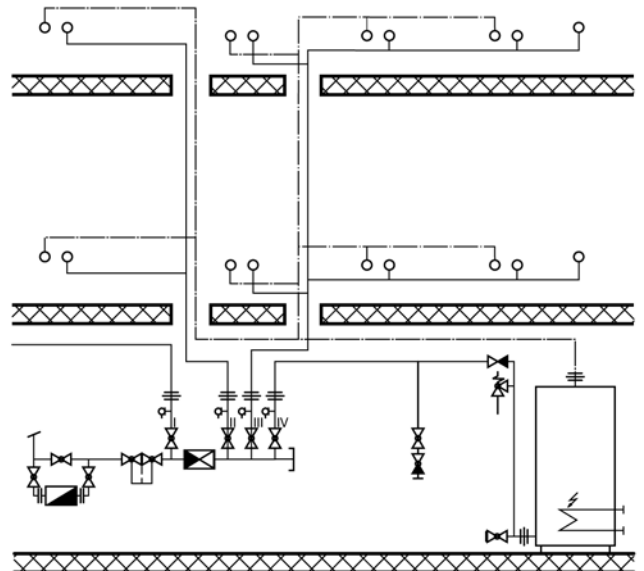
Tubería de distribución, montantes, ramales y conexión a los aparatos
